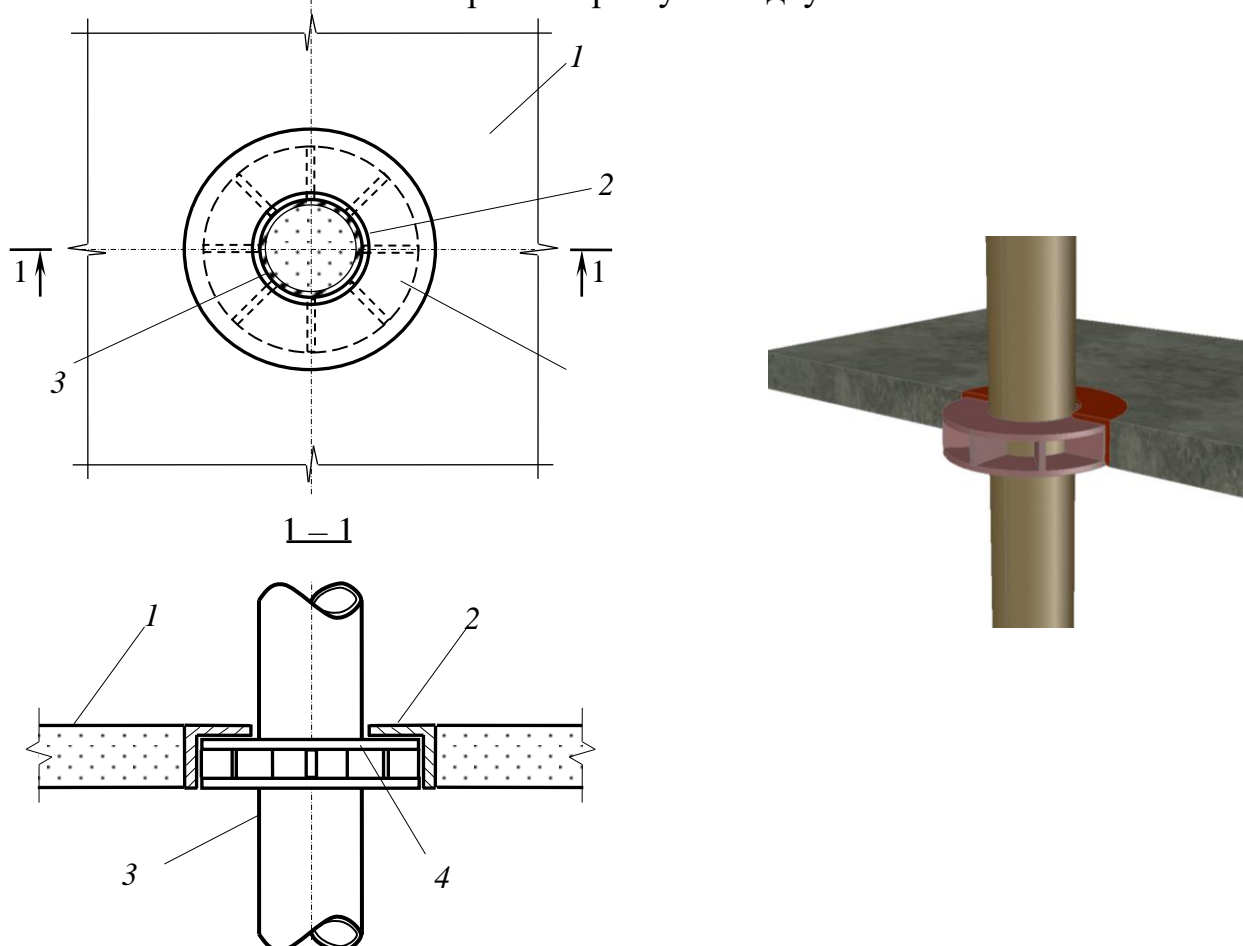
Схема вузла з'єднання надколонної плити сталезалізобетонного безбалкового перекриття з трубобетонною колоною
